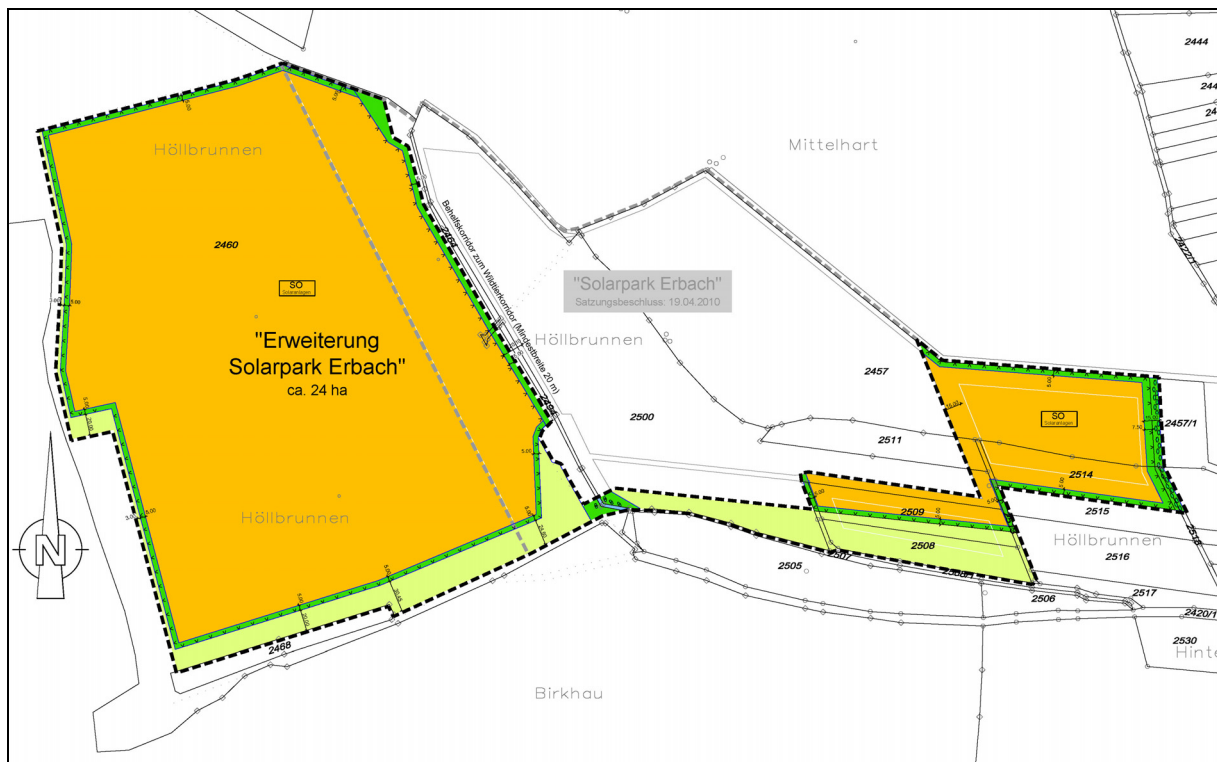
Lageplan zum Bebauungsplan vom 18.08.2021 (ES tiefbauplanung)
